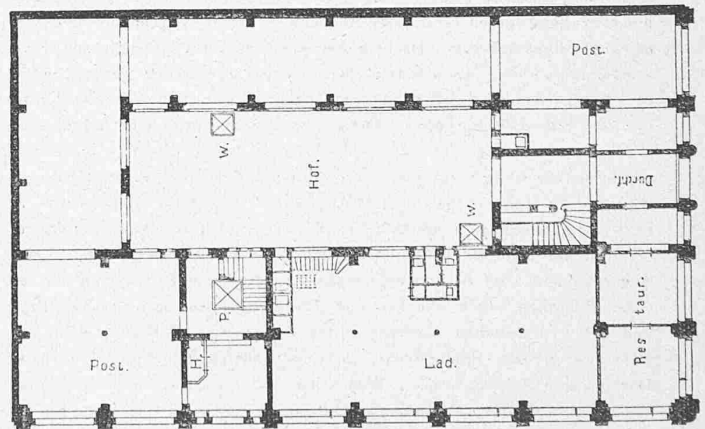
Erdgeschoss-Grundriss vom Kaufhaus Joseph in Berlin. 1:400.
